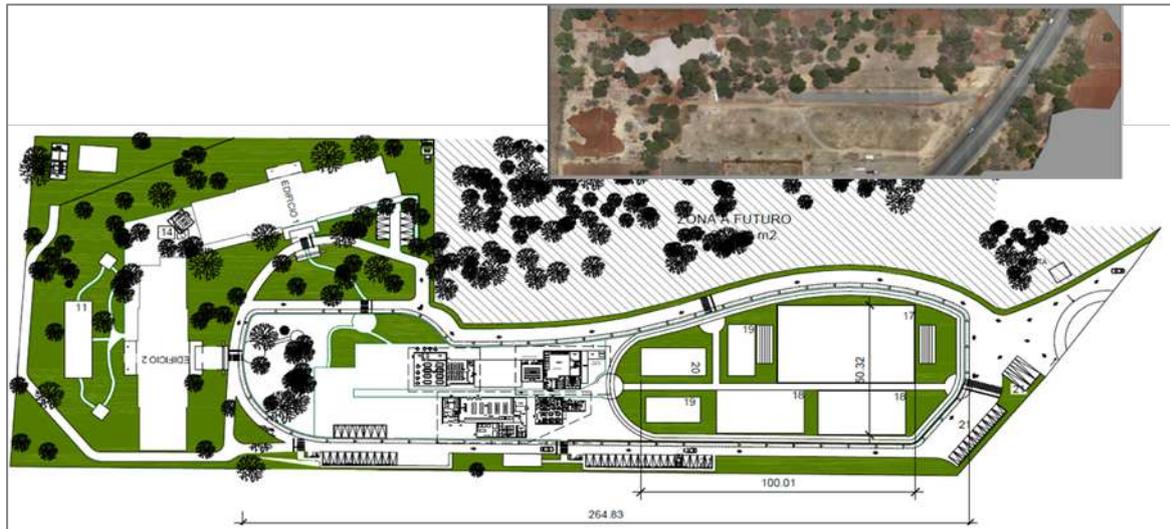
Planta de Conjunto a escala de la cubierta arbórea.
